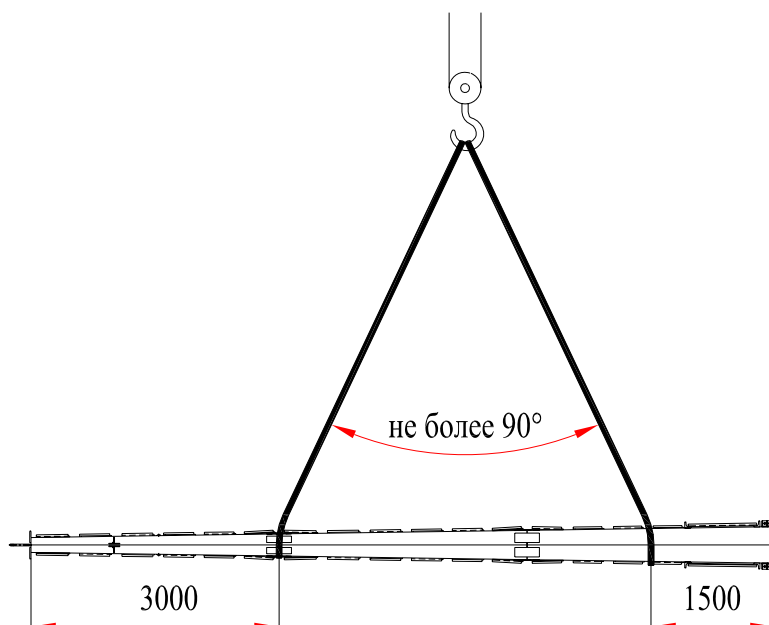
Схема строповки анкерно-угловых и конечных металлических опор из гнутого профиля.
